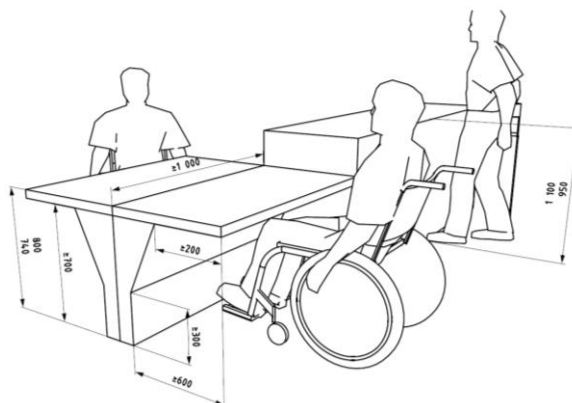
Hauteurs de guichets, étagères ou écrivoires accessibles
